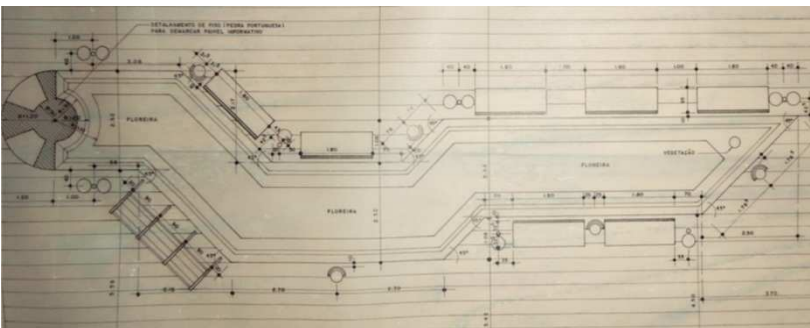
Planta baixa do Calçadão Salvador Isaia (trecho junto à Rua Floriano Peixoto) conforme projeto do final da década de 90. FONTE: Arquivo IPLAN-SM.
